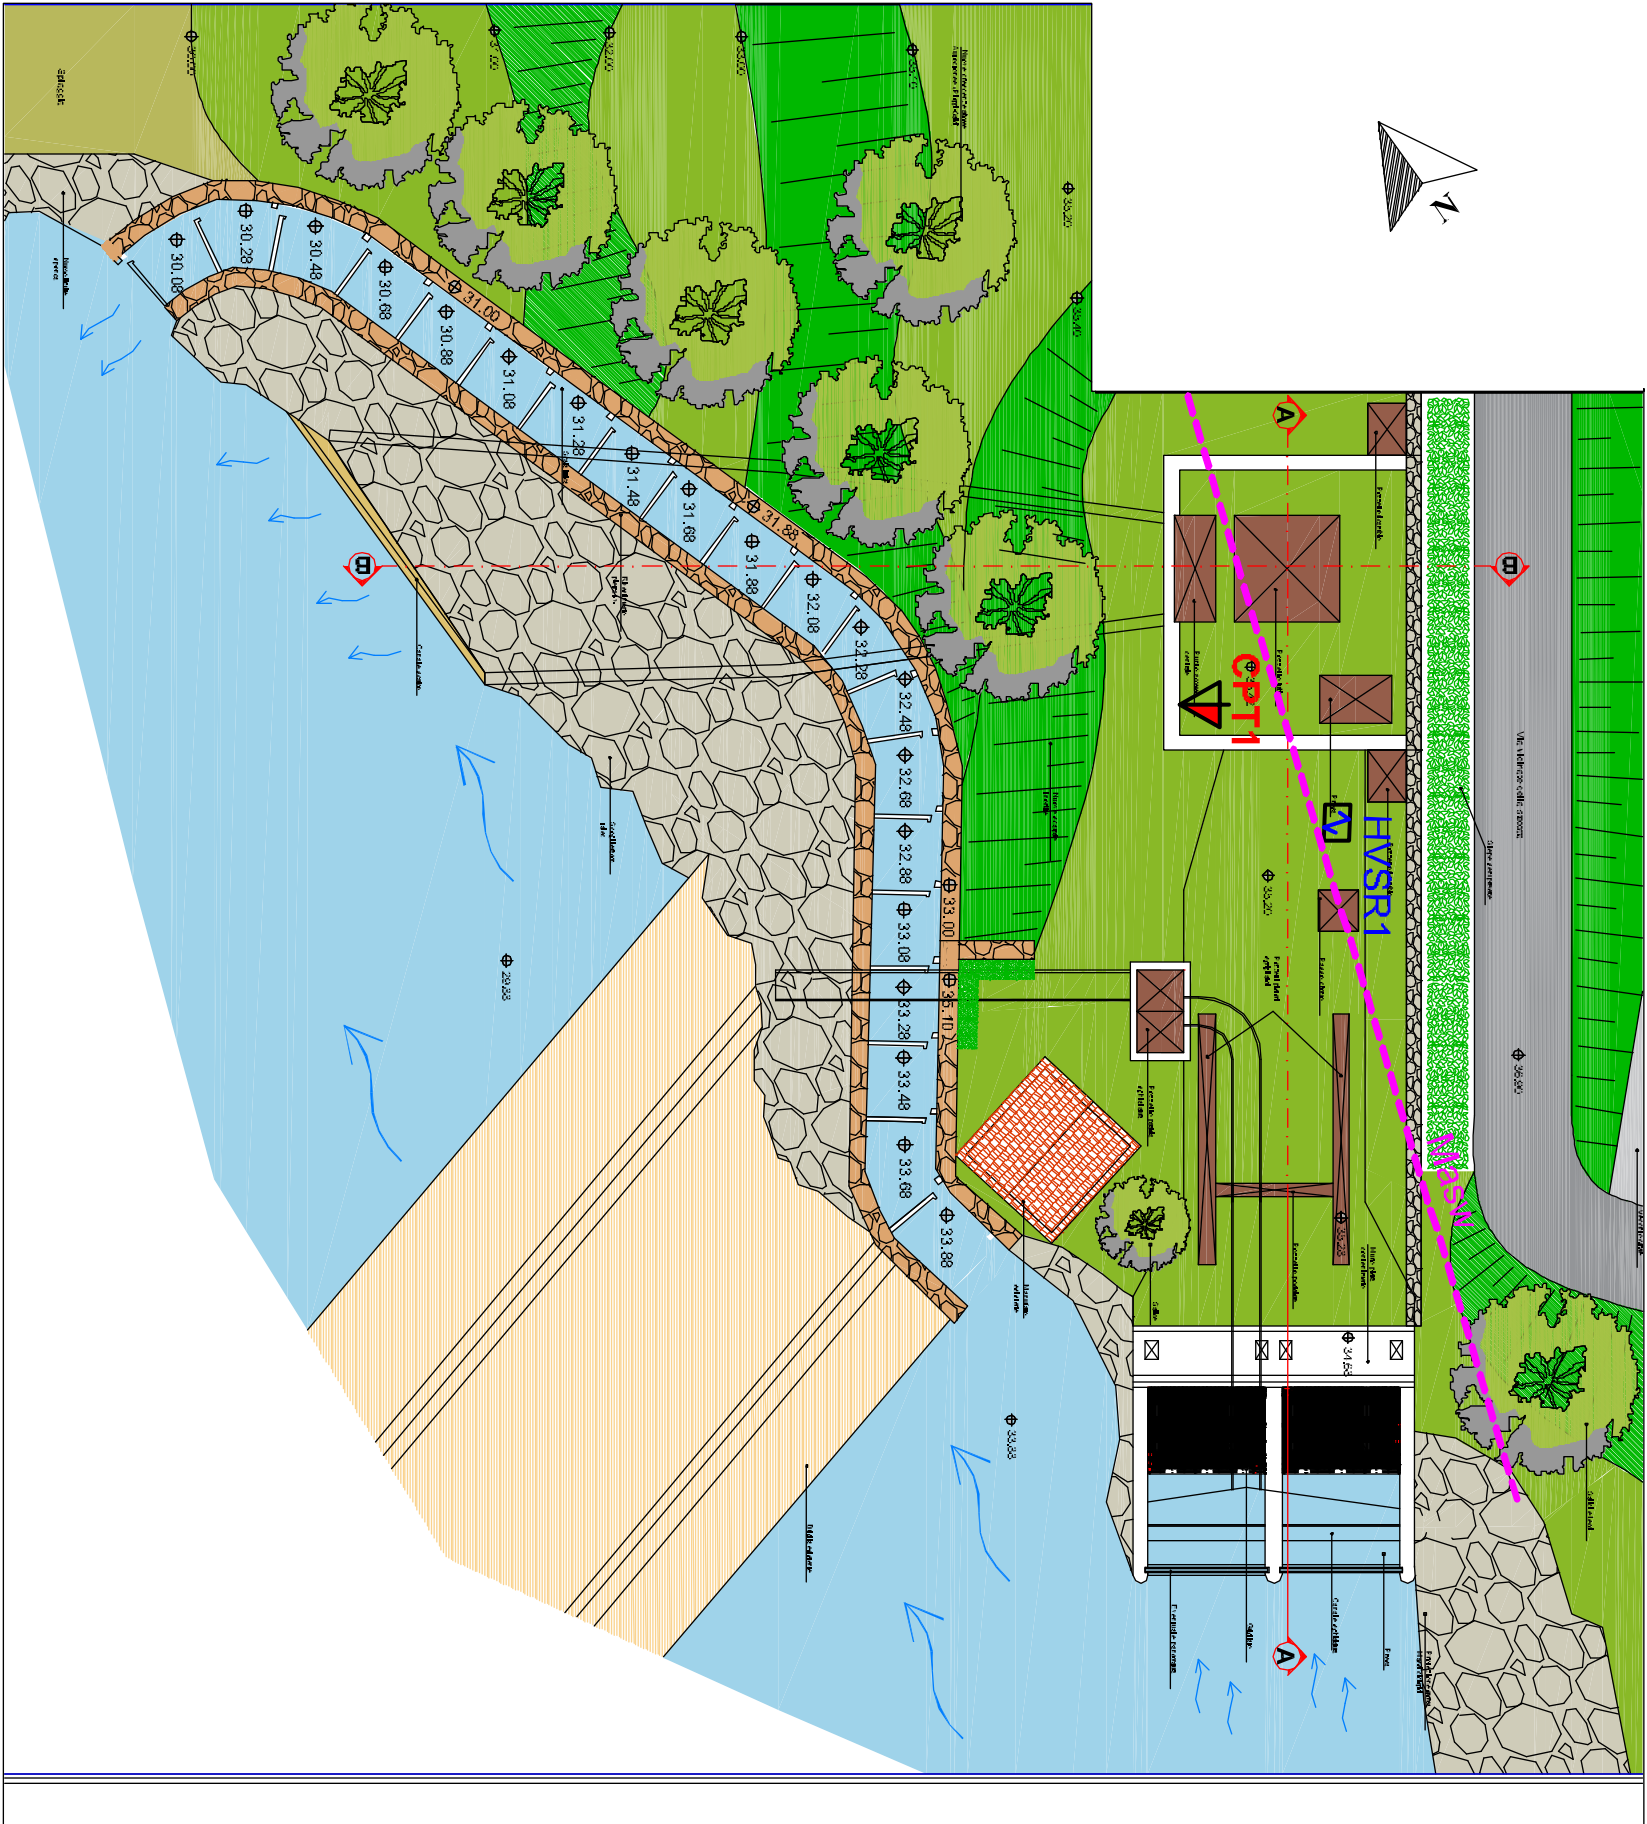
A - PLANIMETRIA CON UBICAZIONE DELLE INDAGINI IN SITU
